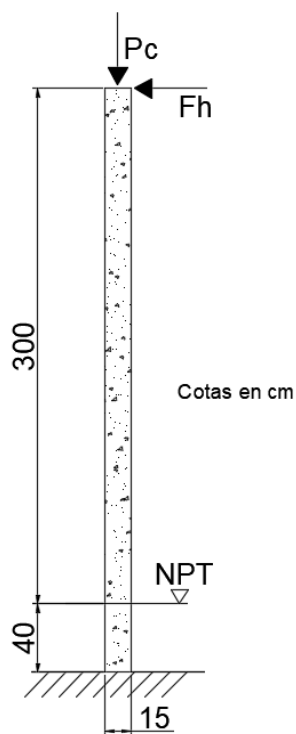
Vista frontal de la columna de concreto, con las fuerzas aplicadas.
